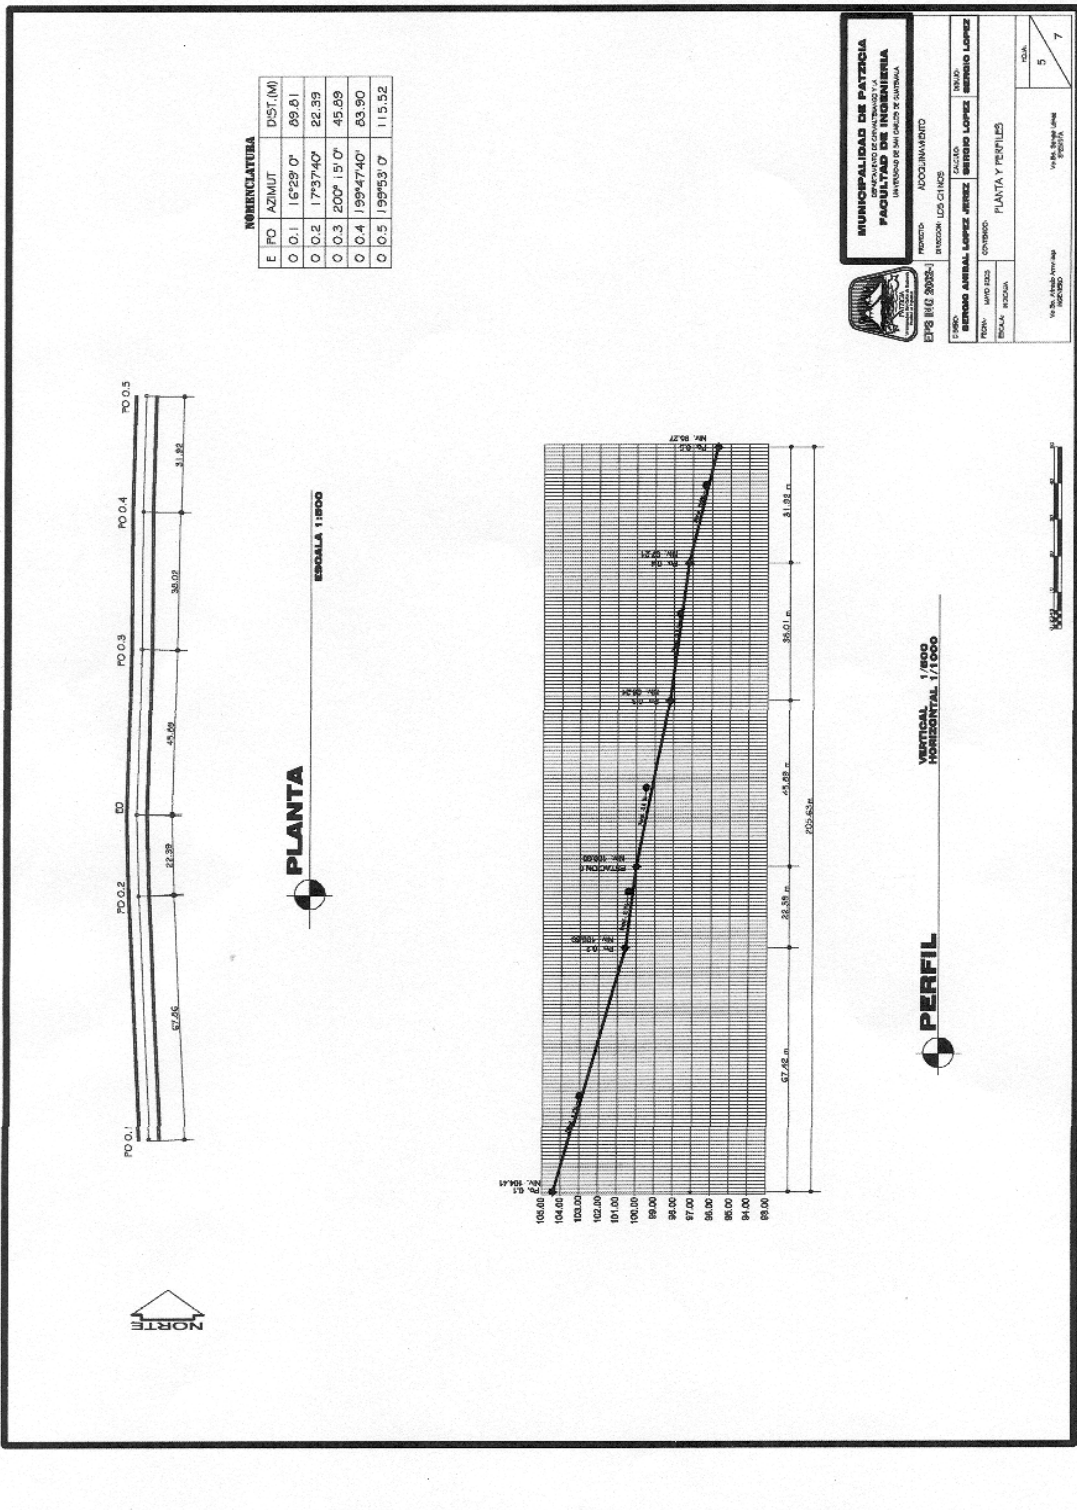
Plano de la planta/perfil de la calle Chi Rosario
